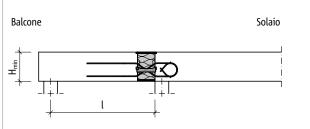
Schöck Isokorb® XT tipo QL-VV: schema statico (XT tipo QL-VV1 – VV4)
